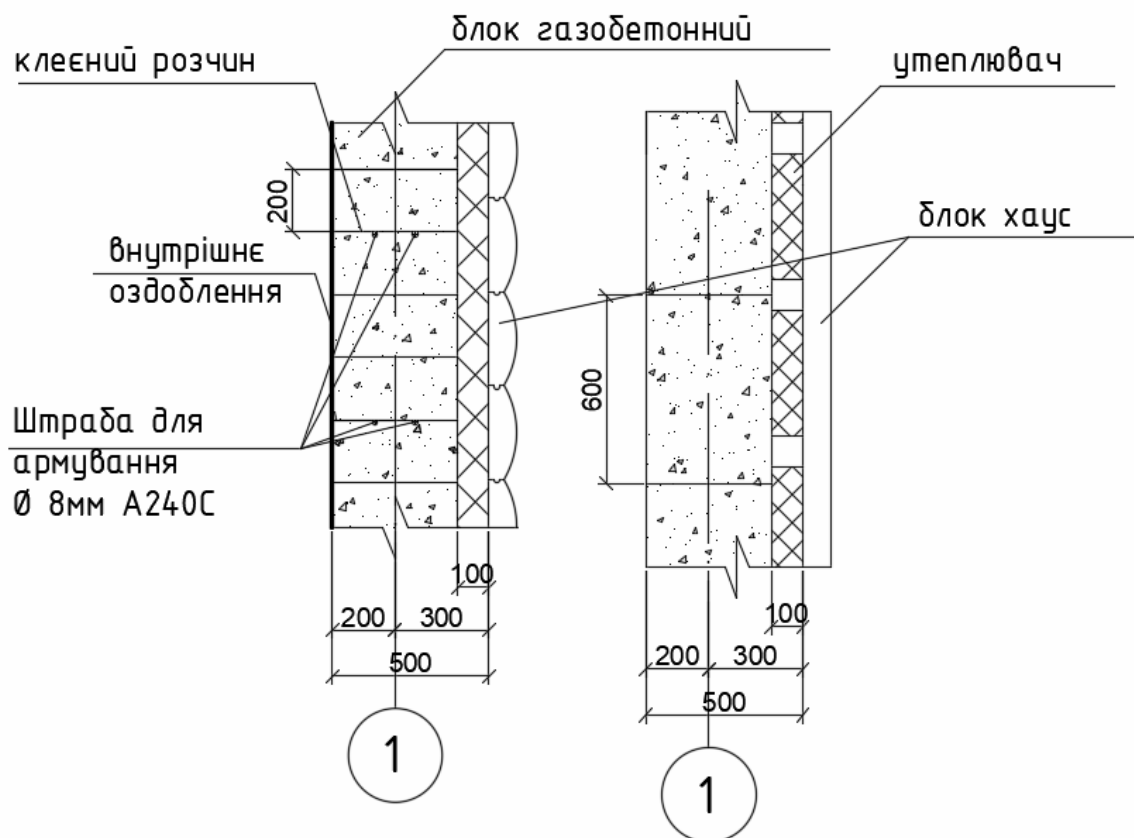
Поперечний та поздовжній вузол стіни з газобетонних блоків
